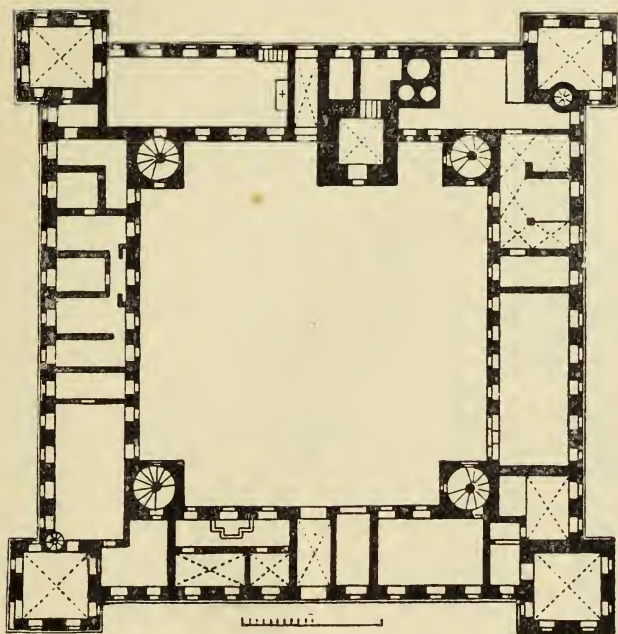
Schloss Aschaffenburg. Grundriss. (Zu S. 11.)
